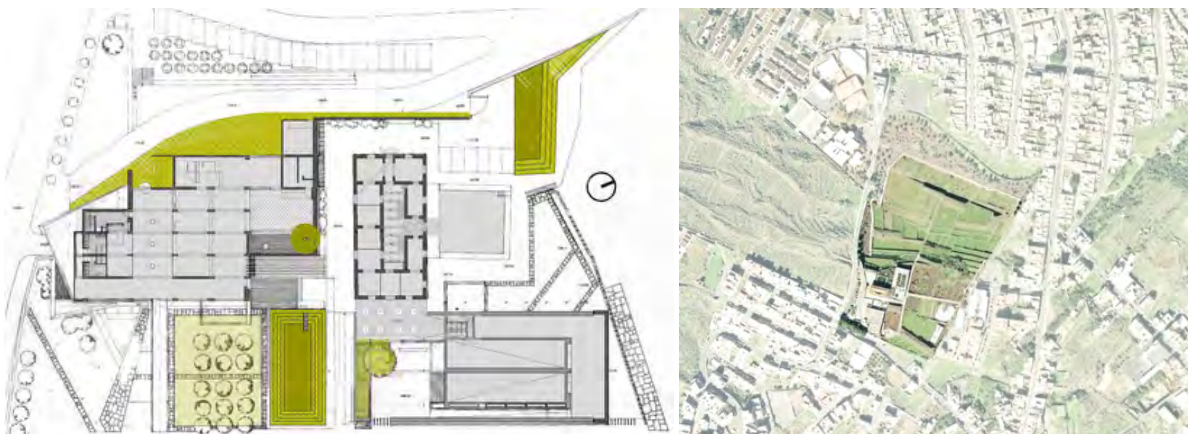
Pianta piano terra e Planimetria generale - fonte delle immagini Euleb
